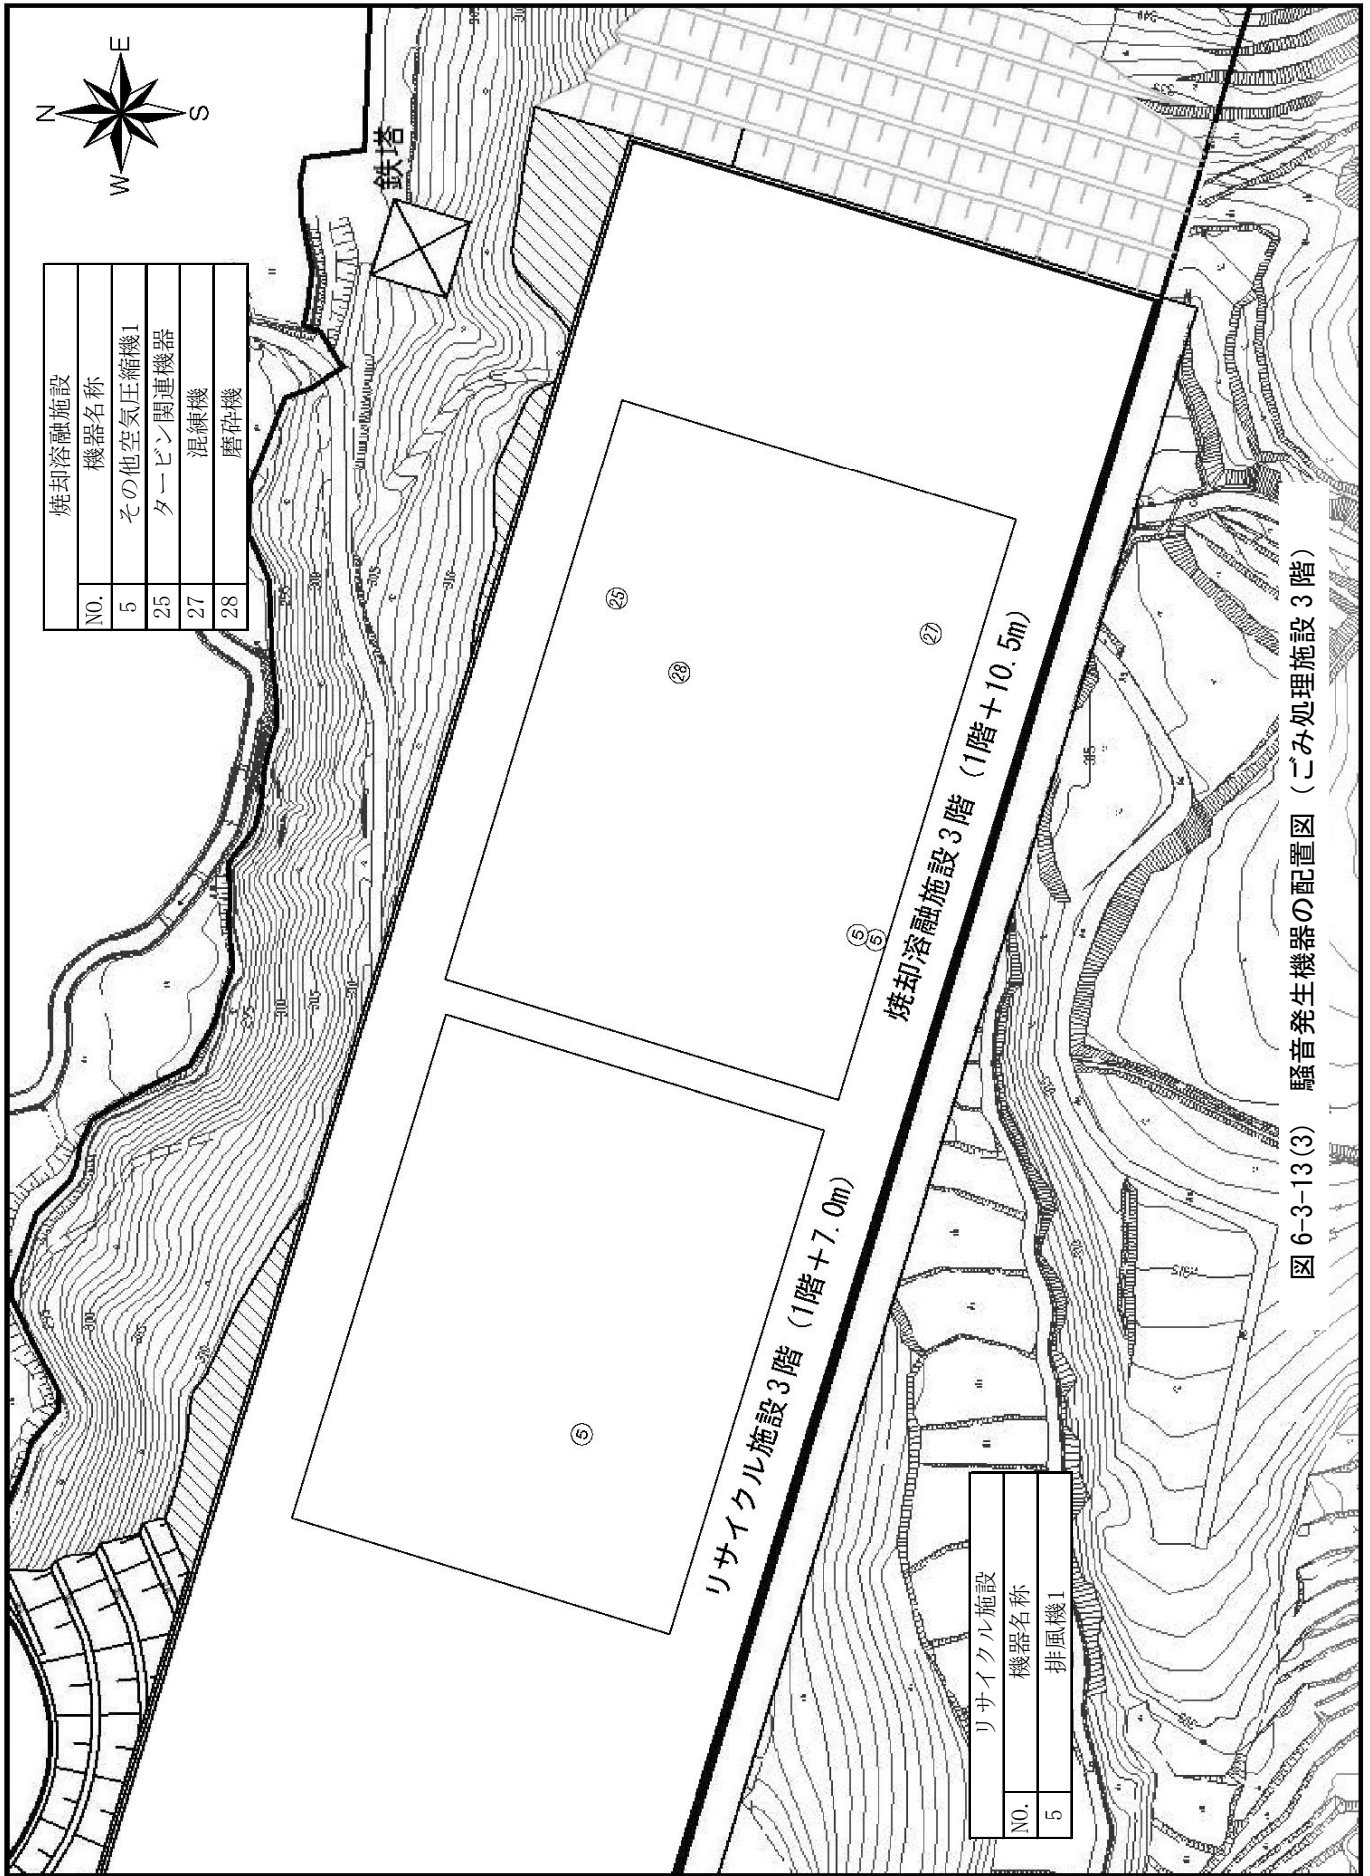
(3) 騒音発生機器の配置図 (ごみ処理施設 3階)
